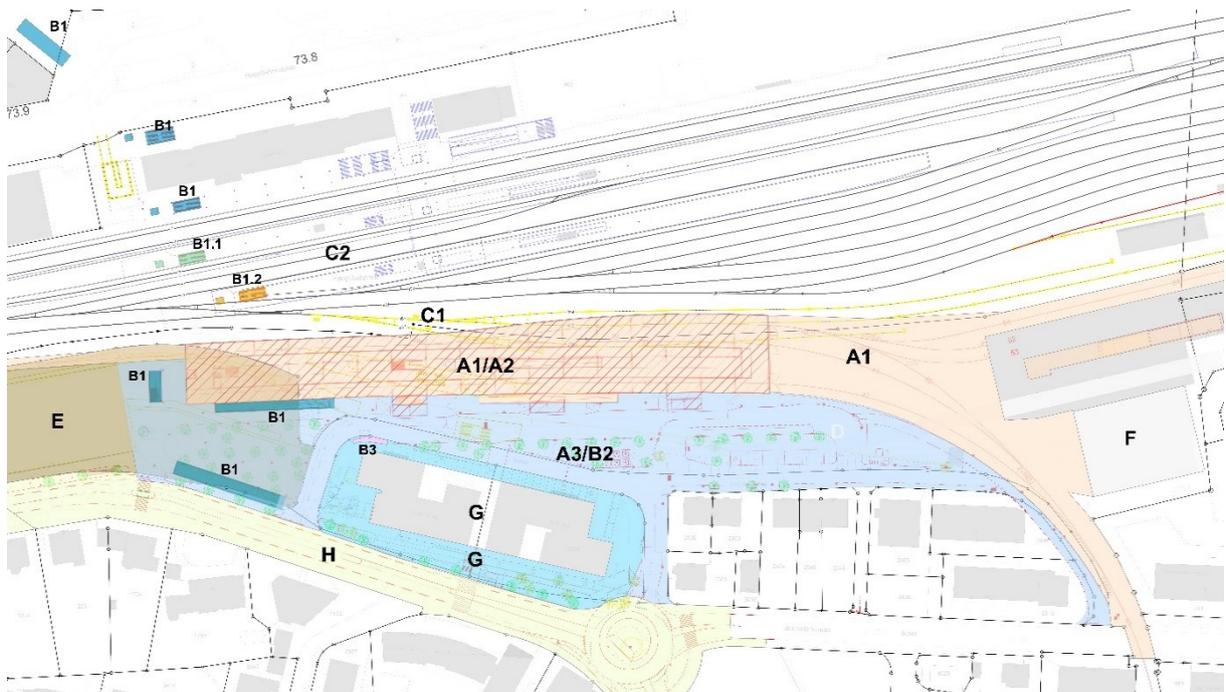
; Planausschnitt Situation auf Ebene Erdgeschoss mit Darstellung der Module
